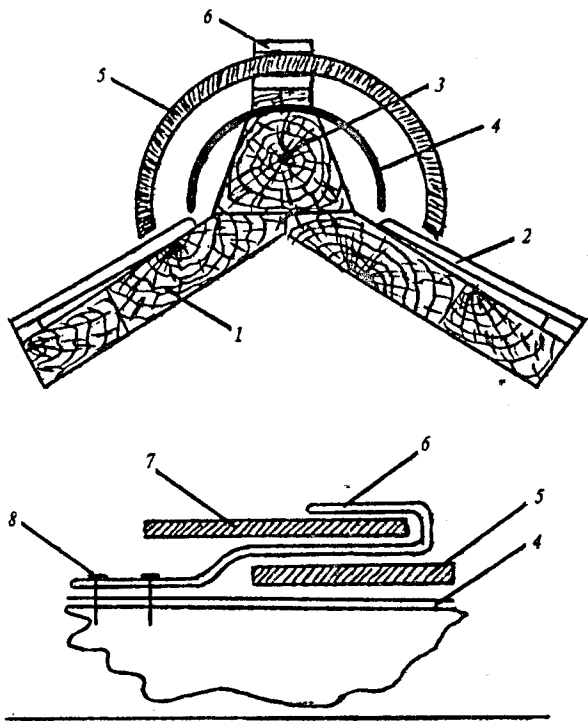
Покриття конька: 1 – кроквяна нога; 2 – шифер; 3 – коньковий брус; 4 – руберойдова стрічка; 5 – жолобчастий коньок; 6 – скоба; 7 – накриваючий кінець жолобчастого конька; 8 – цвях.
